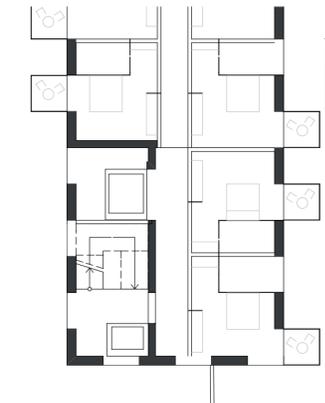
Wohnungstyp 1, erschlossen über den hofseitigen Laubengang, mit großzügiger Wohnküche inklusive Loggia, Schlafzimmer und Badezimmer.
